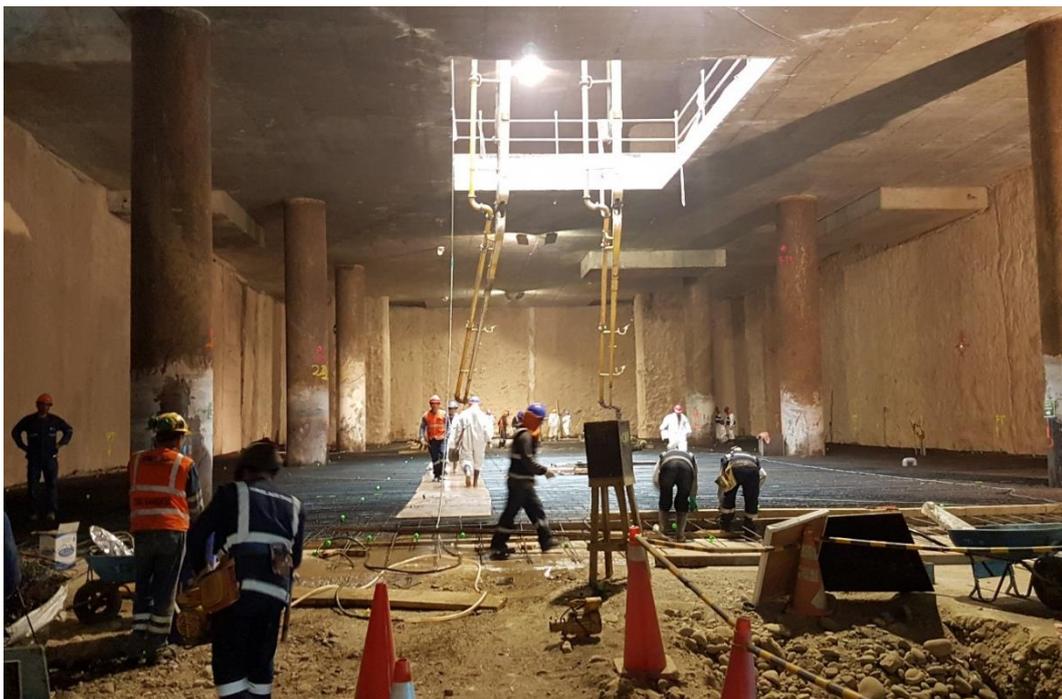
Hormigonado masivo de una fase de losa de fondo.
